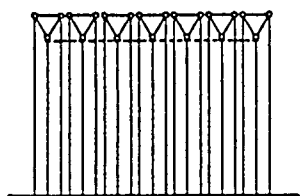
Disposição transversal das peças pré-fabricadas de três membros
